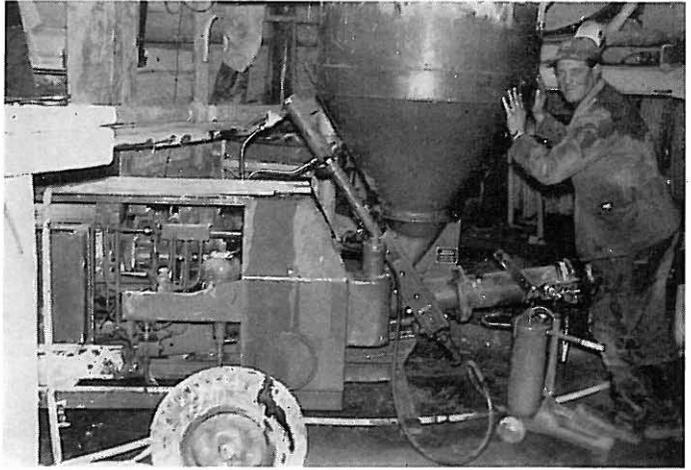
Hydraulisch angetriebene Betonpumpe im Tunnelbau; stündliche Förderleistung bis zu 6 m<sup>3</sup> (Typ PT 6 der Fa. Torkret GmbH)
